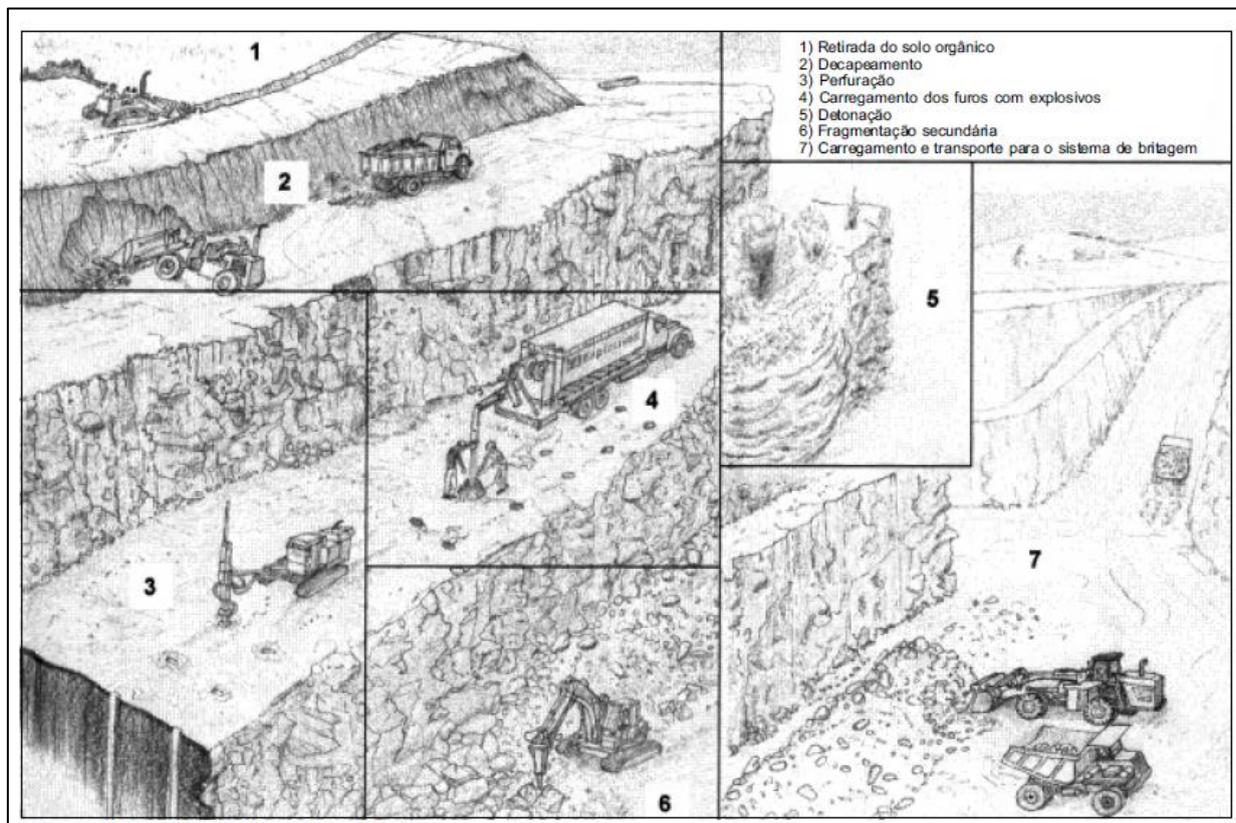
Layout esquemático de atividade de extração de basalto, aplicado para a área de interesse.
